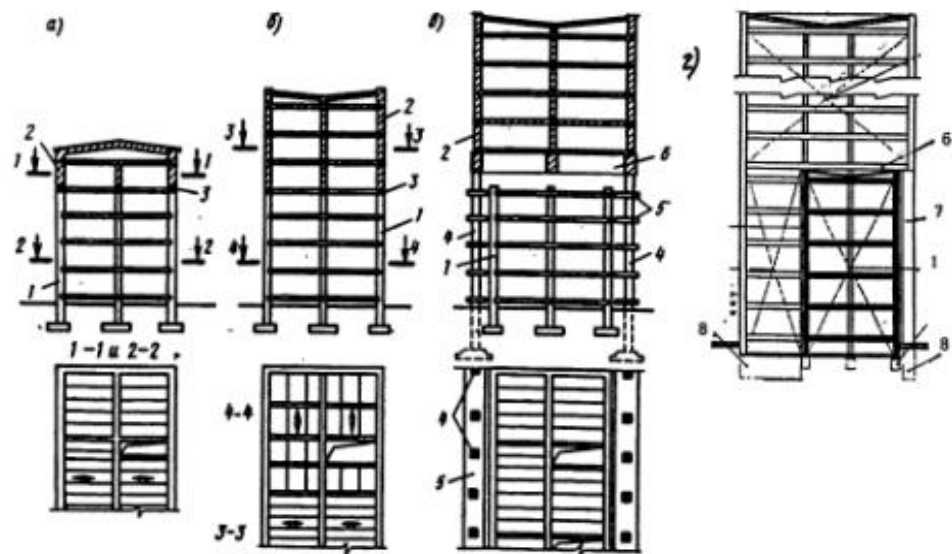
Конструктивные решения надстроек: а – с сохранением конструктивной системы надстраиваемого здания, б – с изменением конструктивной системы, в – на самостоятельных опорах системы "фламинго", не нагружающих надстраиваемое здание; г – не нагружающая асимметричная надстройка и пристройка, расширяющая здание; 1 – основное здание, 2 – надстройка, 3 – монолитный пояс-обвязка, 4 – колонны, 5 – плиты лоджий – горизонтальные связи колонн, 6 – несущий ростверк; 7 – пилон, 8 – новые фундаменты
